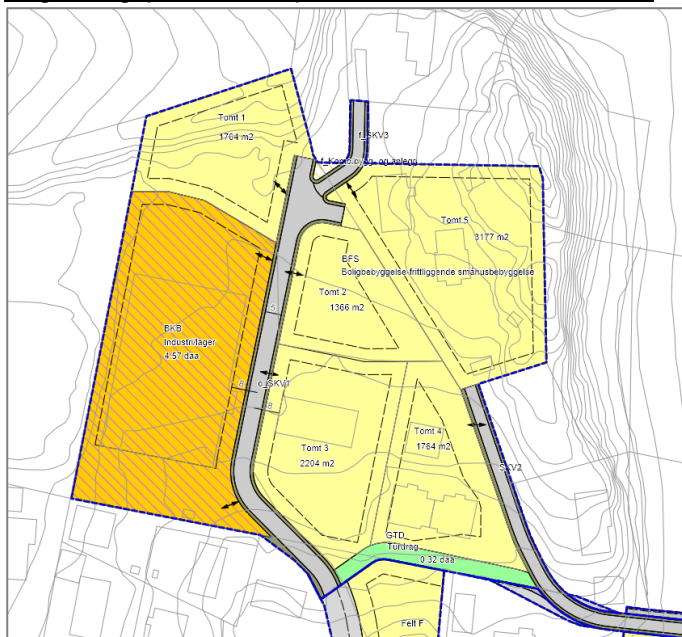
Reguleringsplan for Haugland med planID:30472016001
